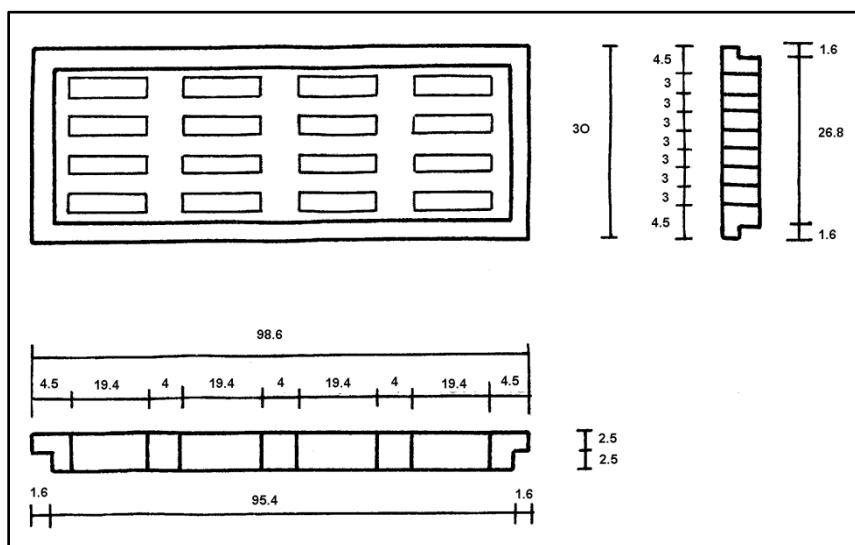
Reja horizontal para tragante (todas las medidas están en centímetros)
